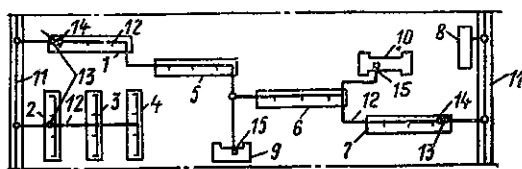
Фрагмент плана микрорайона с водопроводной сетью
